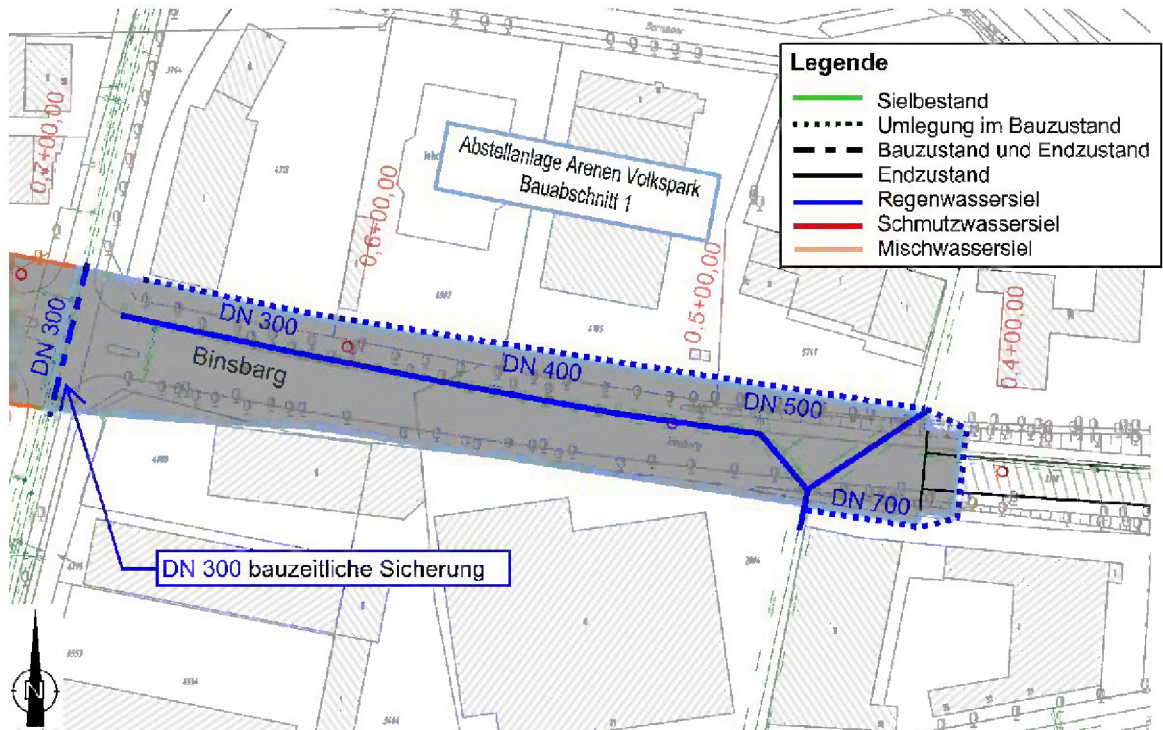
Sielplan Baubereich Abstellanlage Arenen Volkspark, Bauabschnitt 1 (Stand: 04.2019)
